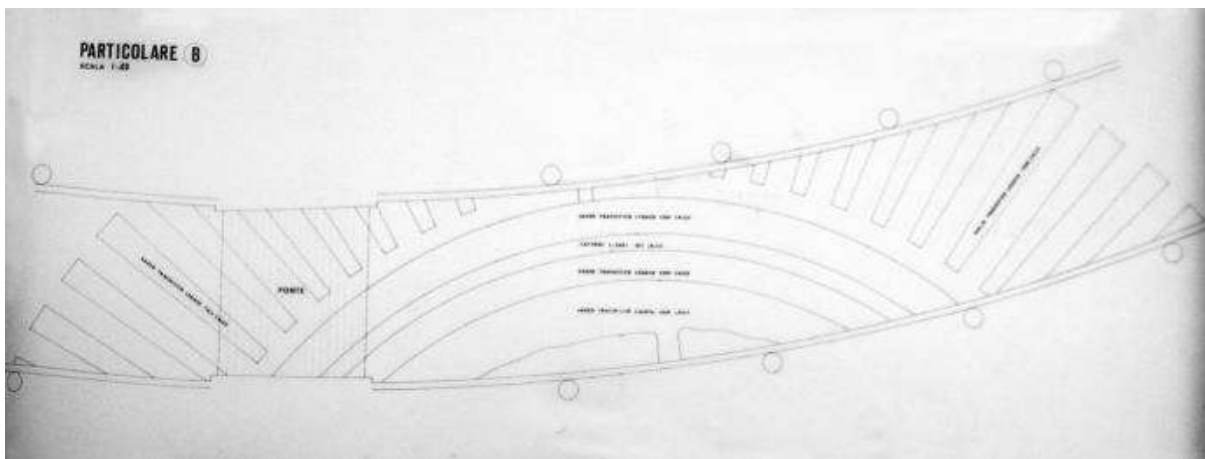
Planimetria delle fondazioni del teatro sul fondo del canale dell'isola Memmia realizzata nel 1984.
